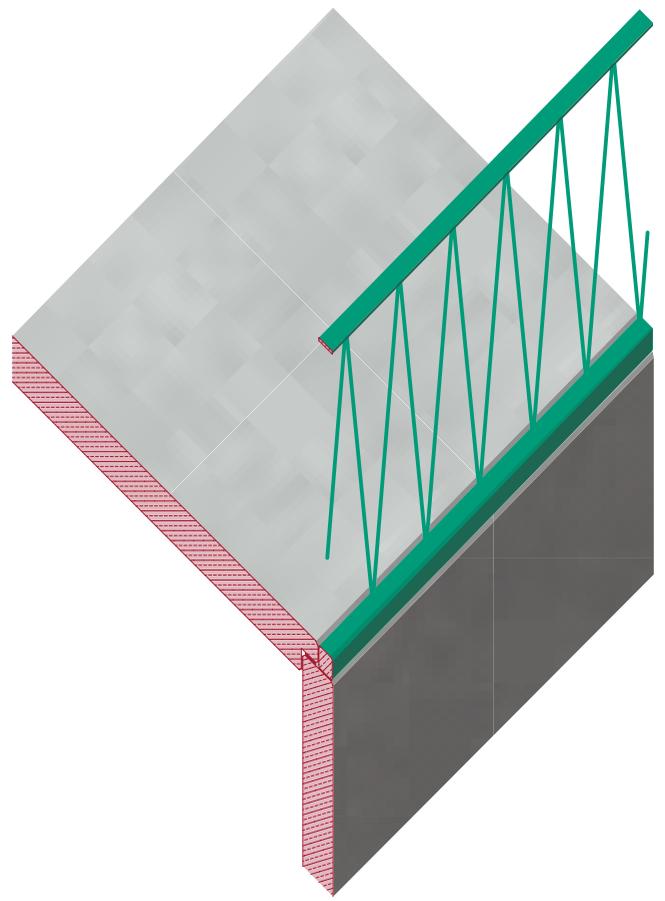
Axonometrischer Schnitt durch Rampe und Rampenbrüstung, Eigene Darstellung, 2024.
